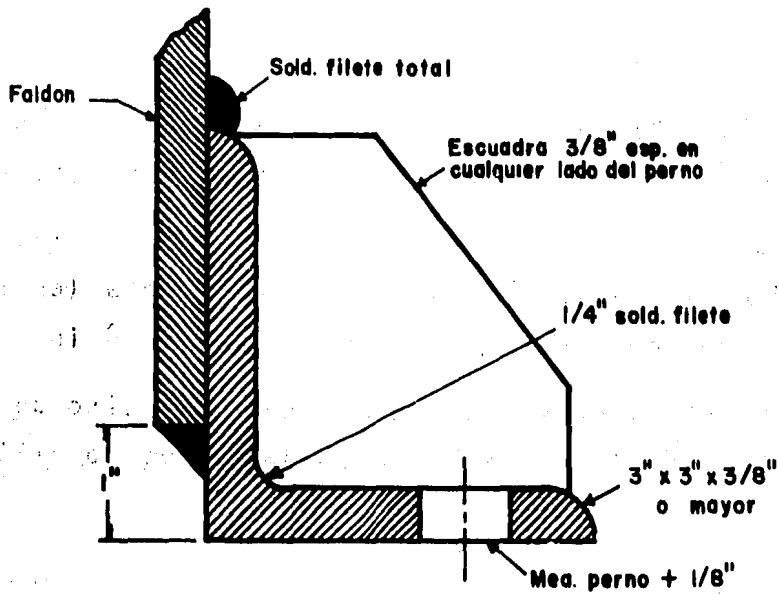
PERFIL DE ANGULO SIMPLE PARA PLACA DE APOYO CON ANGULO DE REFUERZO.
